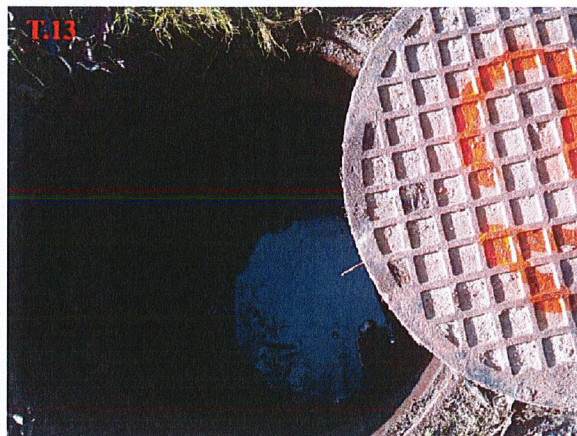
Studnia T.13 - widok wnętrza obudowy
